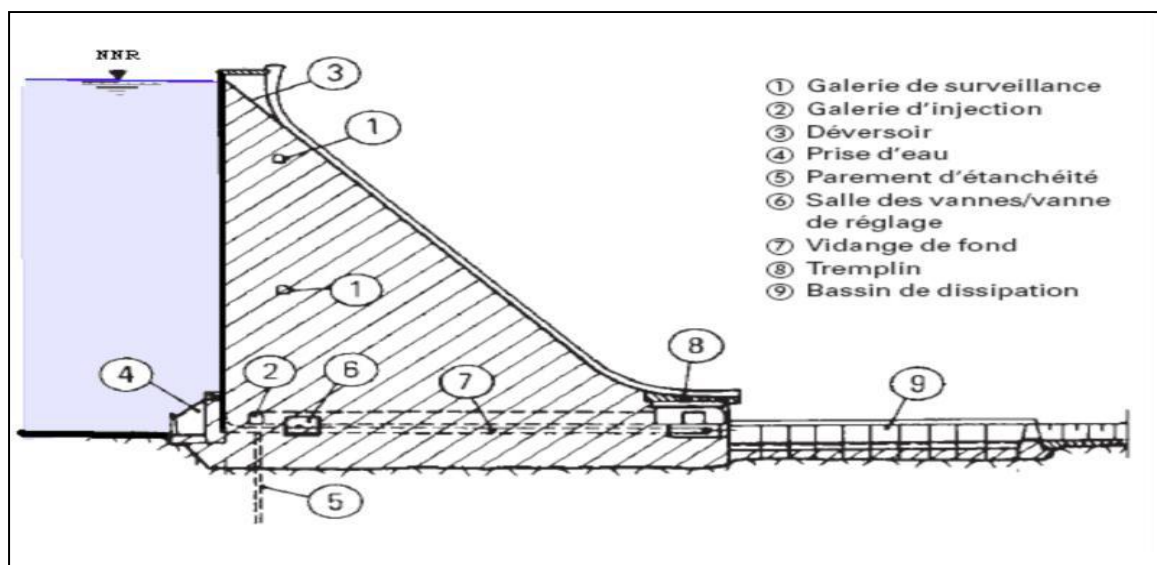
Coupe transversale d'un barrage en béton.[1]
